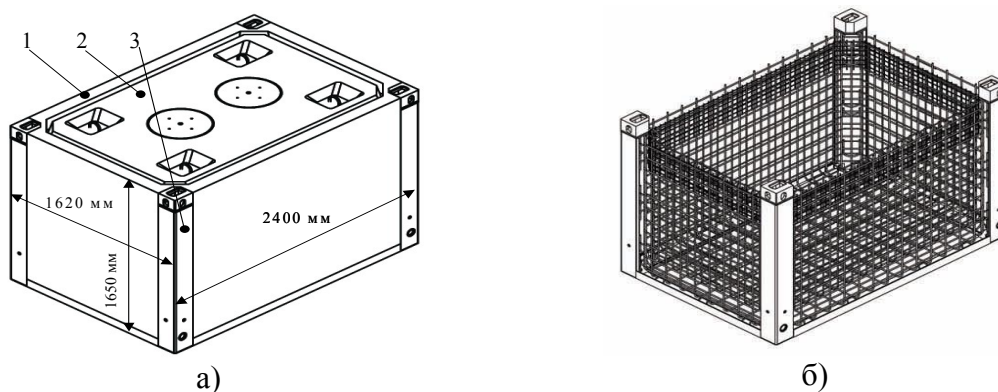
Контейнер: а – загальний вид, де 1 – контейнер, 2 – кришка, 3 – стійки; б – армування корпуса
